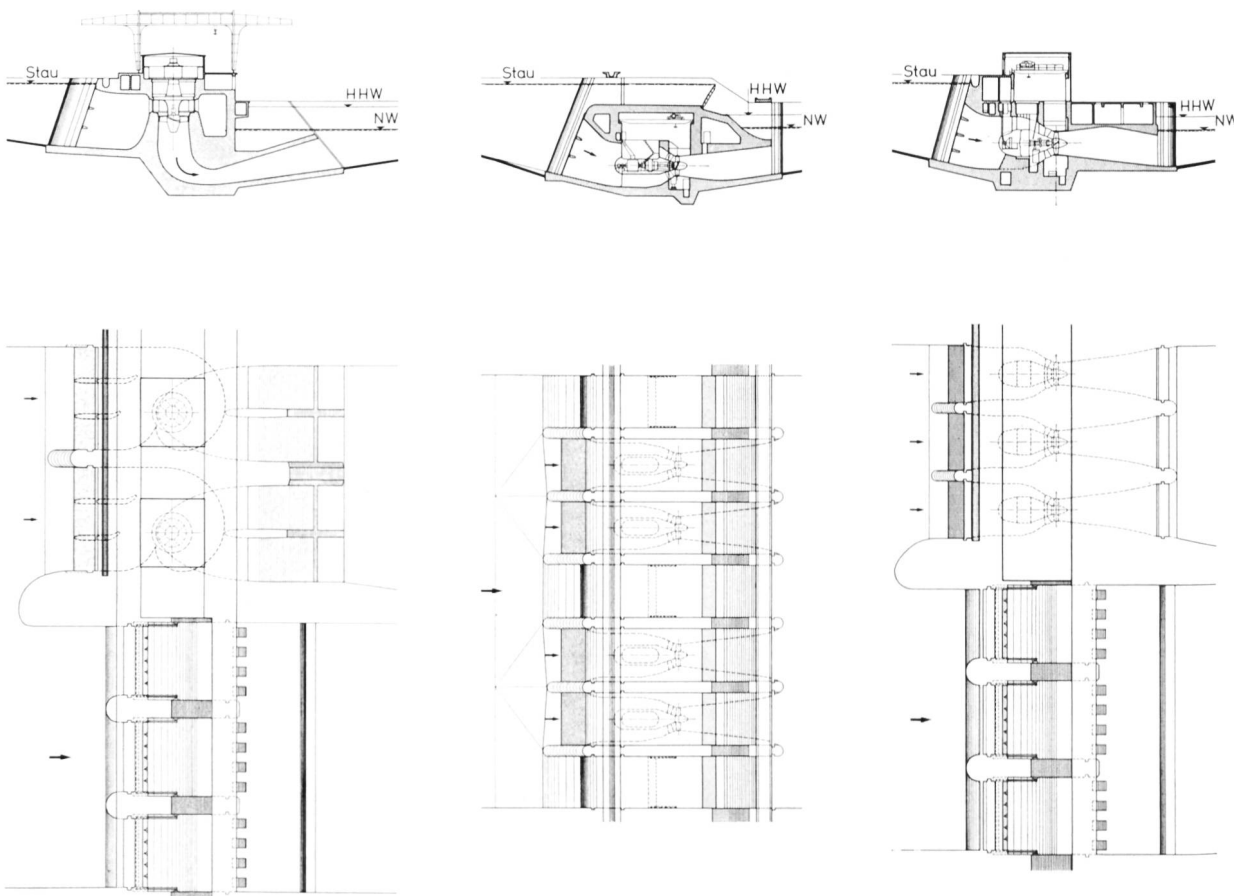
Querschnitte und Grundrisse der untersuchten Kraftwerkvarianten. Links: Flachbauweise mit zwei Kaplan-turbinen. Mitte: Unterwasserbauweise mit vier Rohrturbinen. Rechts: Hochbauweise mit drei Rohrturbinen.
